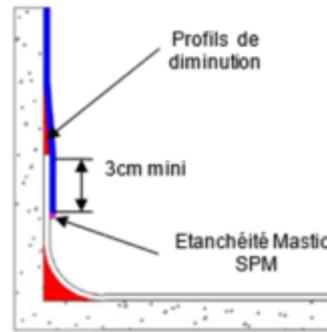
Remontée en plinthe sur sol PVC : joint et chevauchement avec profil de diminution ou enduit
